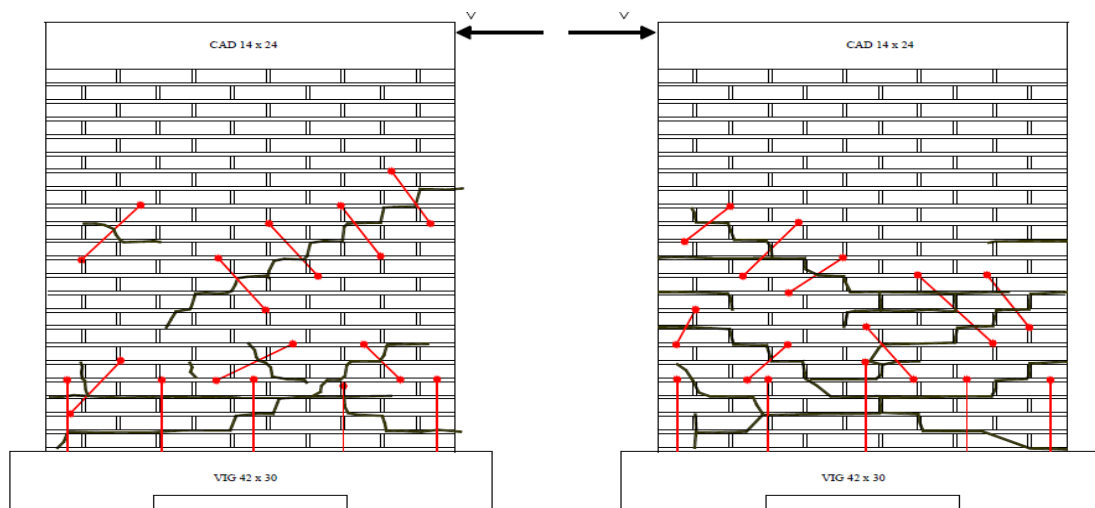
Esquema de la instalación de grapas, en el muro 2. Fuente: CAMPBELL, J, y OTROS. A16-01 *Ensayos de muros de albañilería armada dañados y Reparados sometidos a carga horizontal dinámica.
